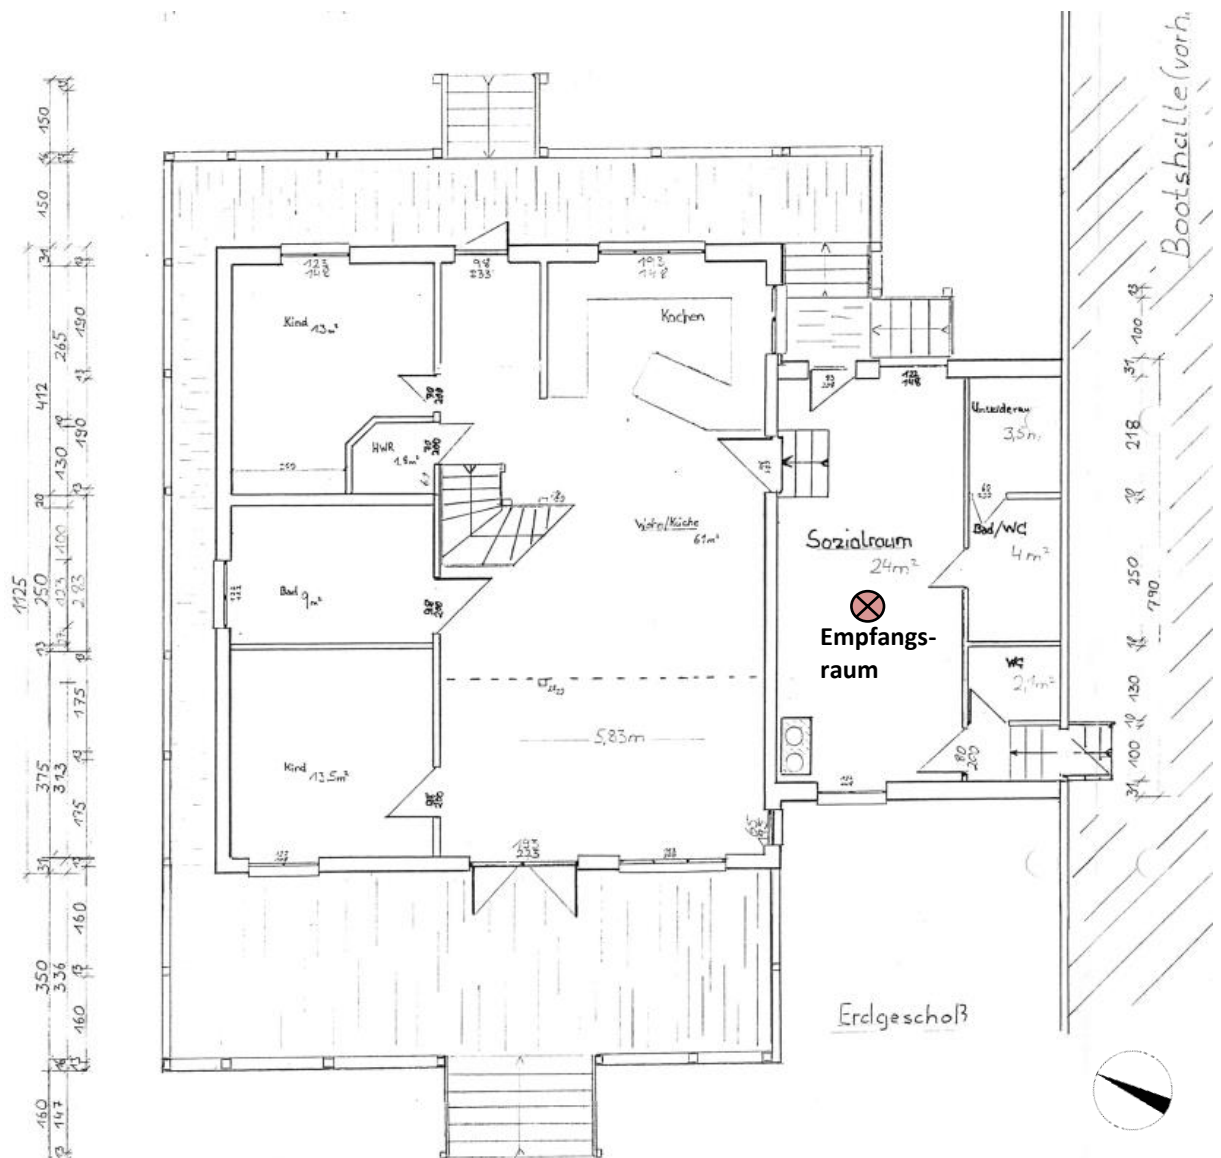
Grundriss Wohnhaus (Königstein 10) mit baulicher Verbindung zur Bootshalle
